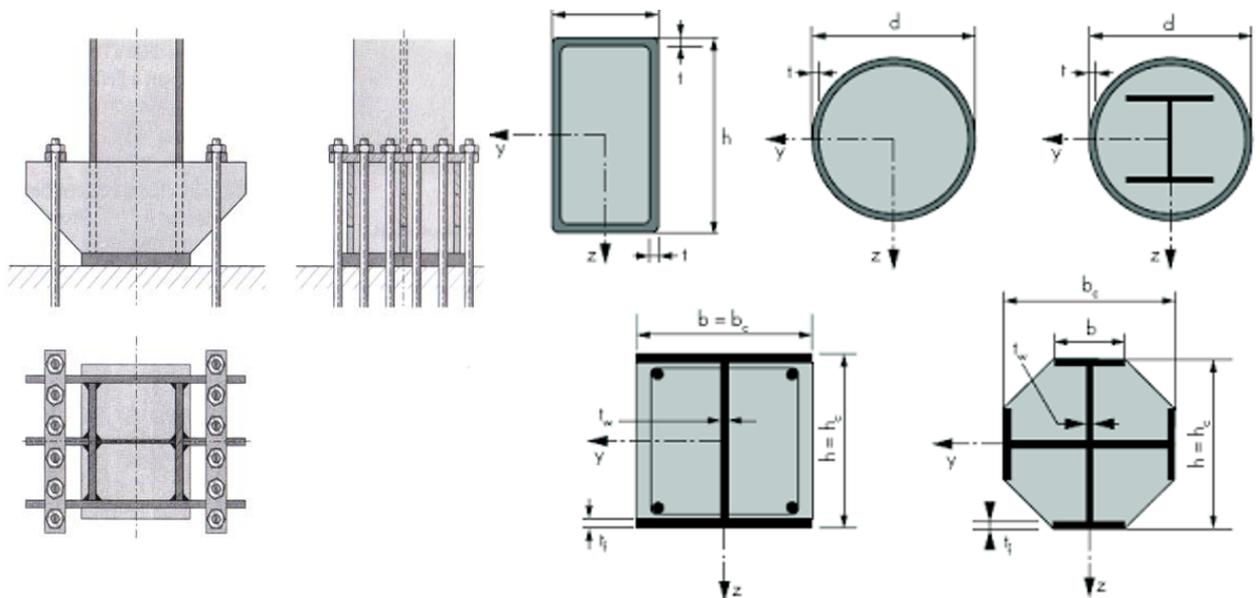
pied du poteaux mixtes et exemple des poteaux mixtes
